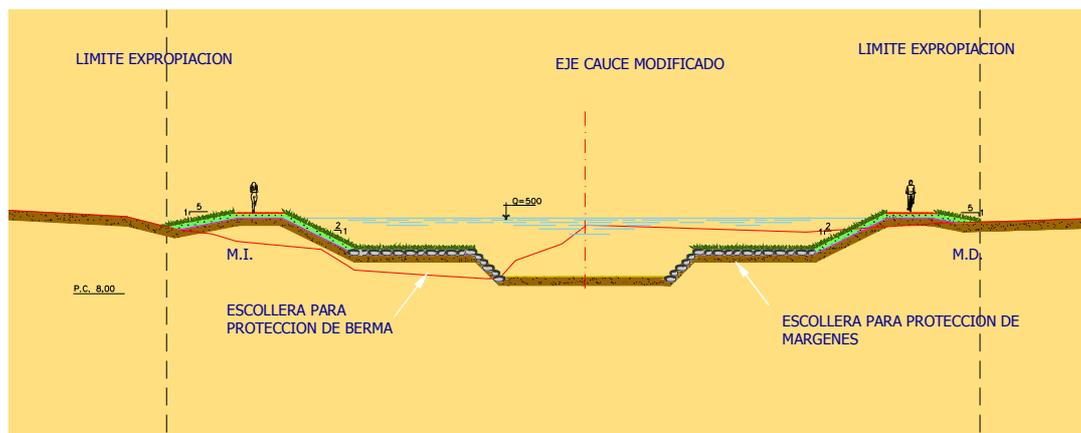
Sección tipo propuesta en el proyecto inicial (Fuente: CHN)
